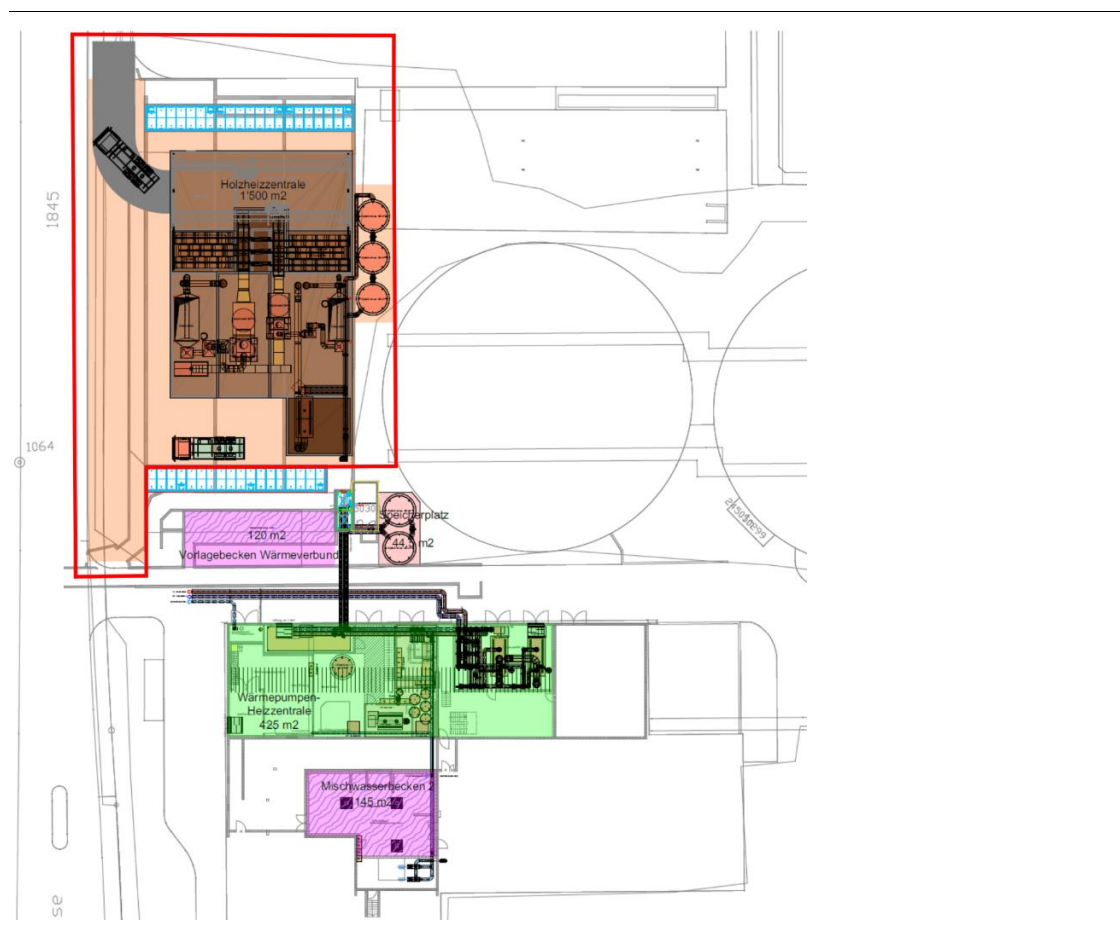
Bestehende Wärmepumpenheizzentrale (grüne Fläche) / geplante Holzheizzentrale (roter Perimeter)
